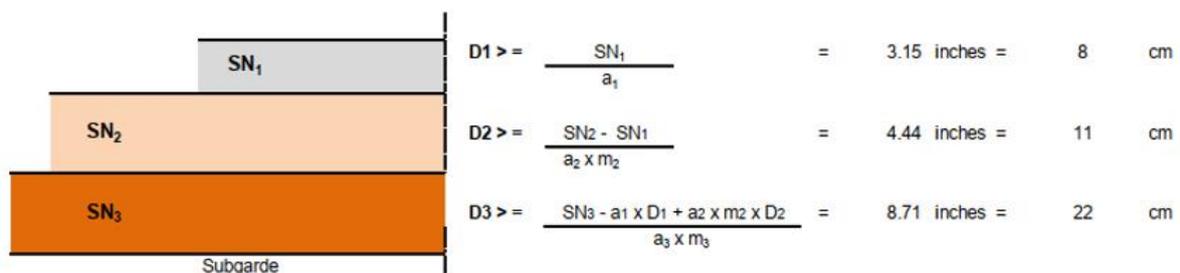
Ketebalan Chip Seal dari setiap lapisan: Lapis Permukaan, Lapis Pondasi Bawah dan Lapis Pondasi Atas
